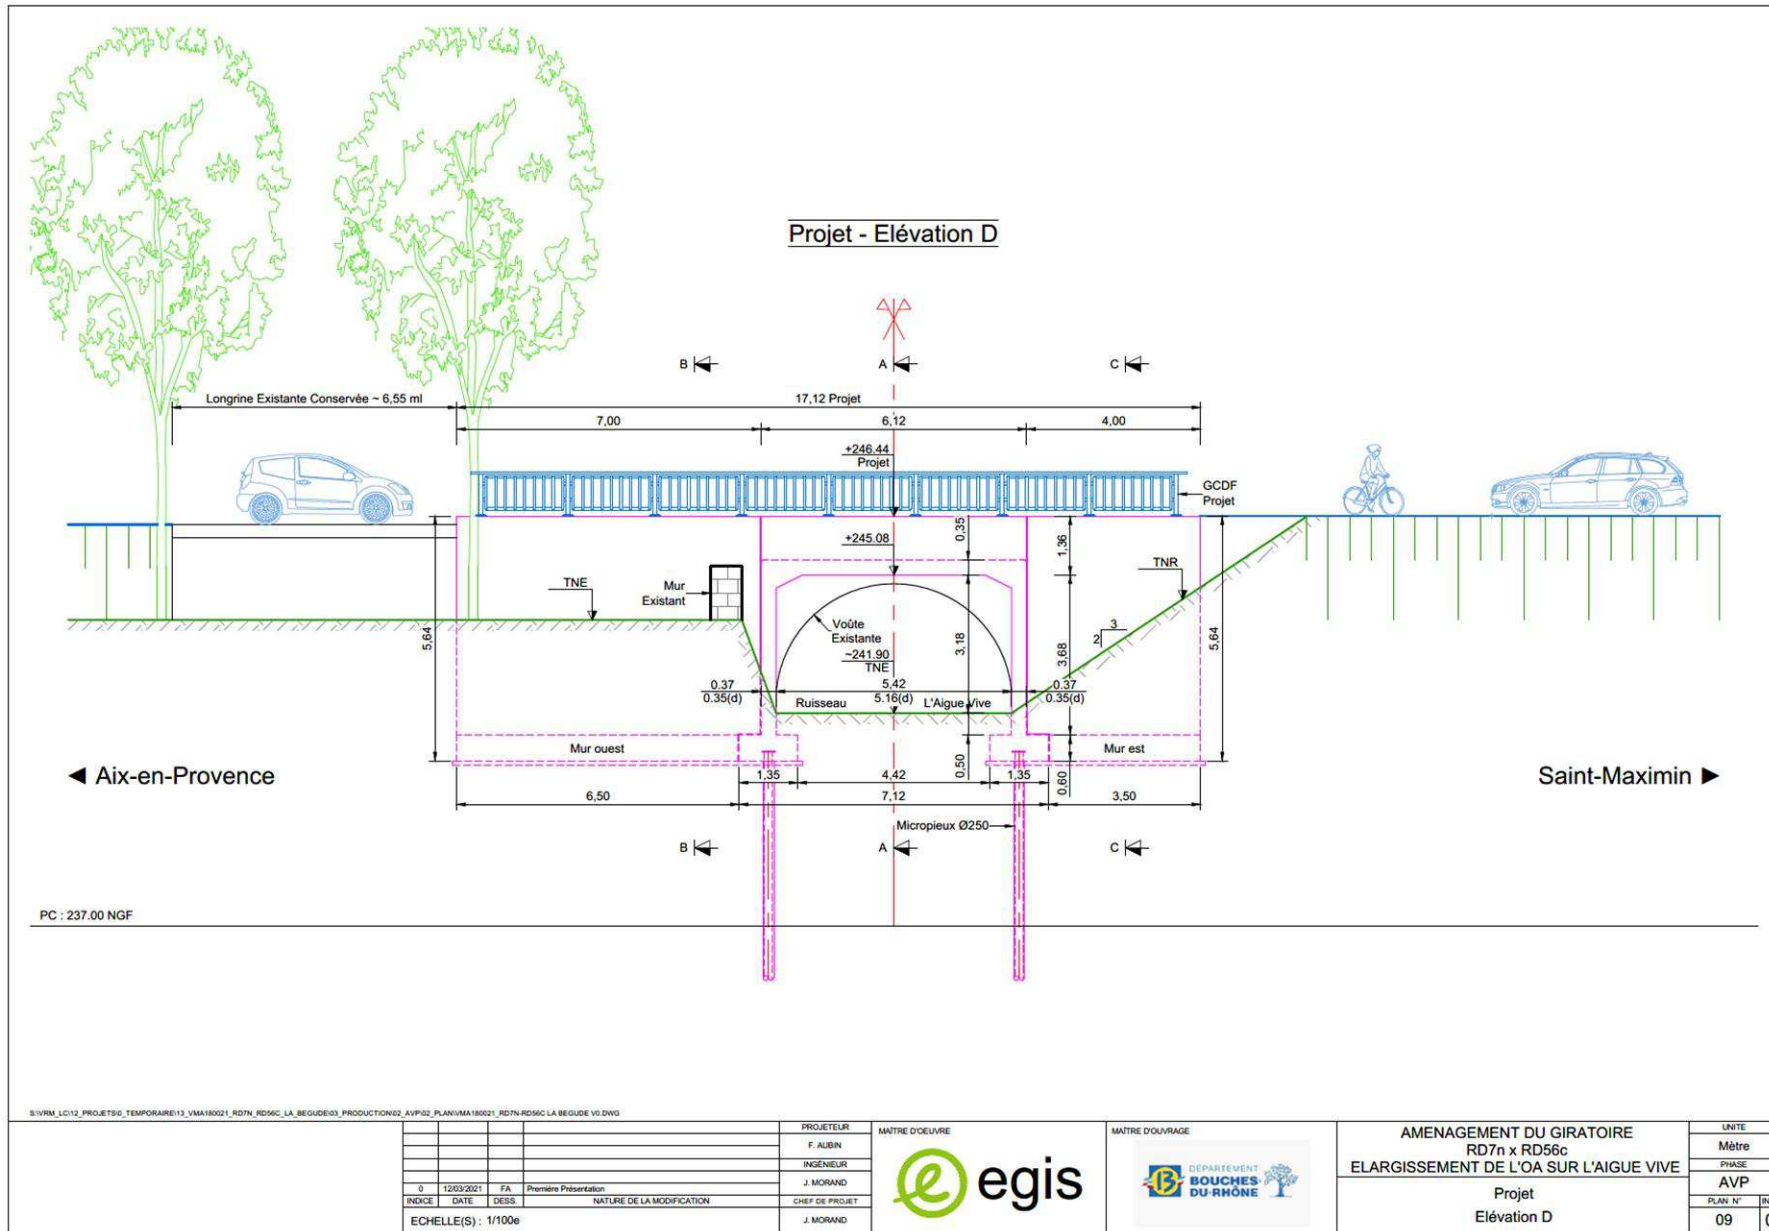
COUPE TRANSVERSALE DE L'OUVRAGE - ÉTAT PROJET
